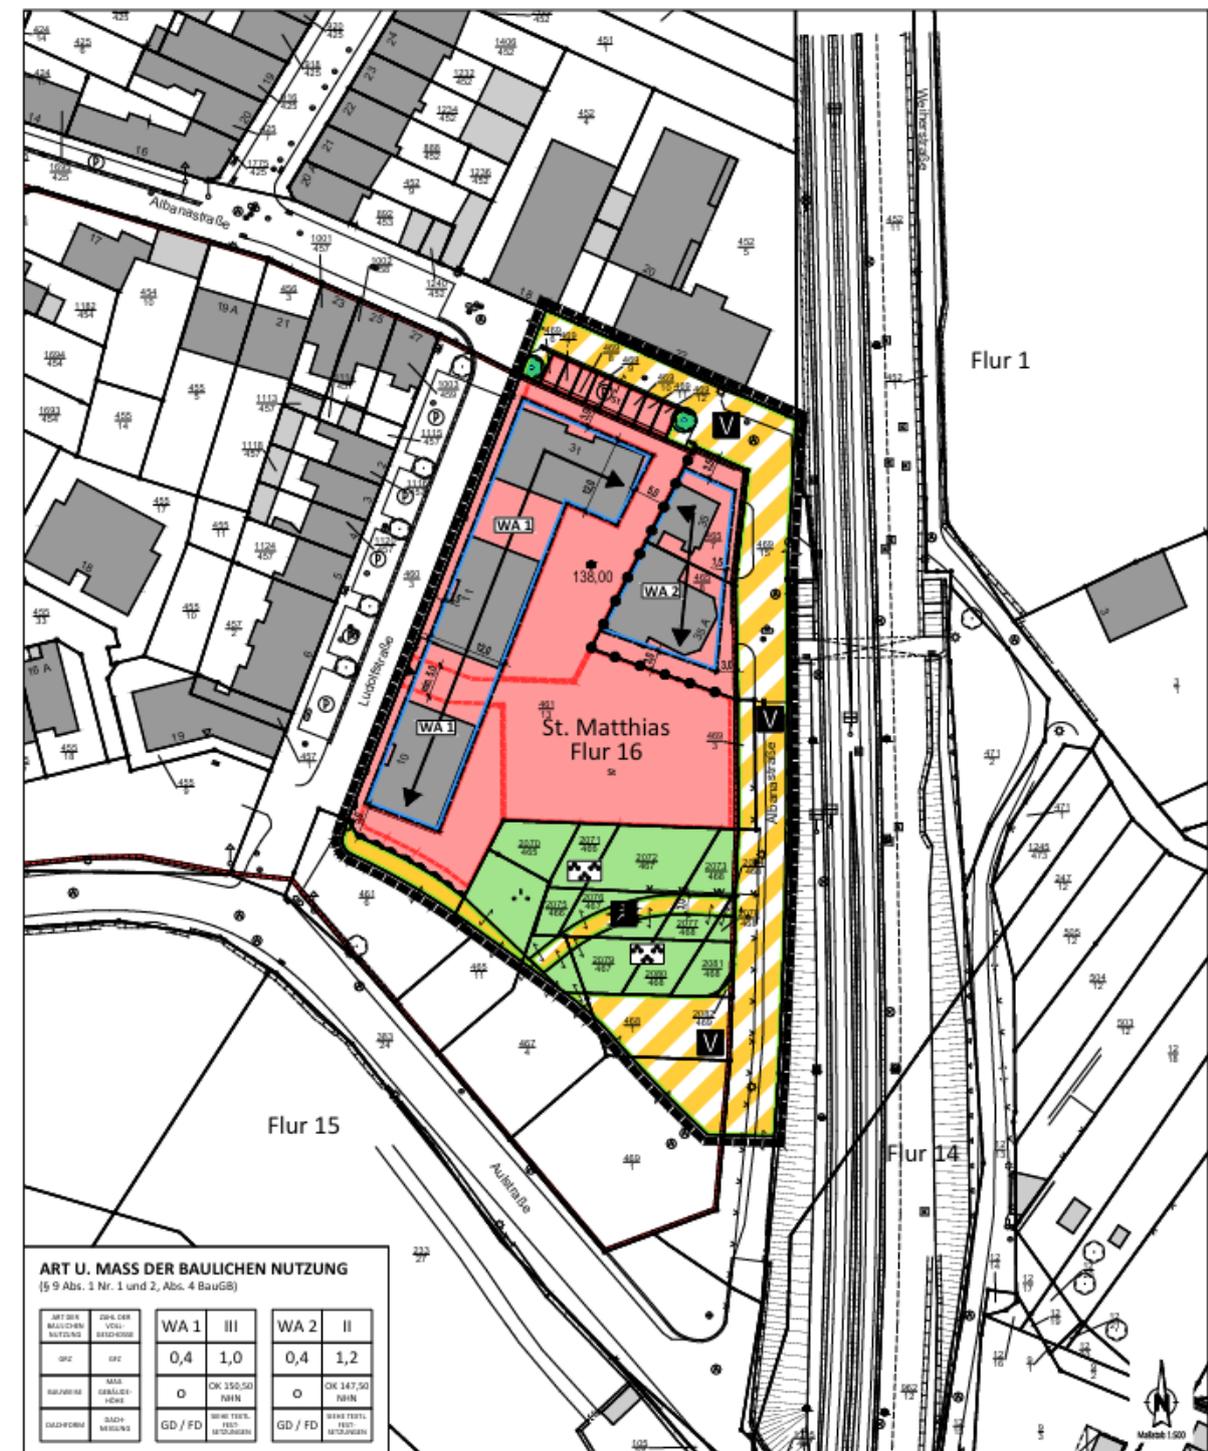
Planausschnitt BS 44 „Östlich der Ludolfstraße“ (2021)
